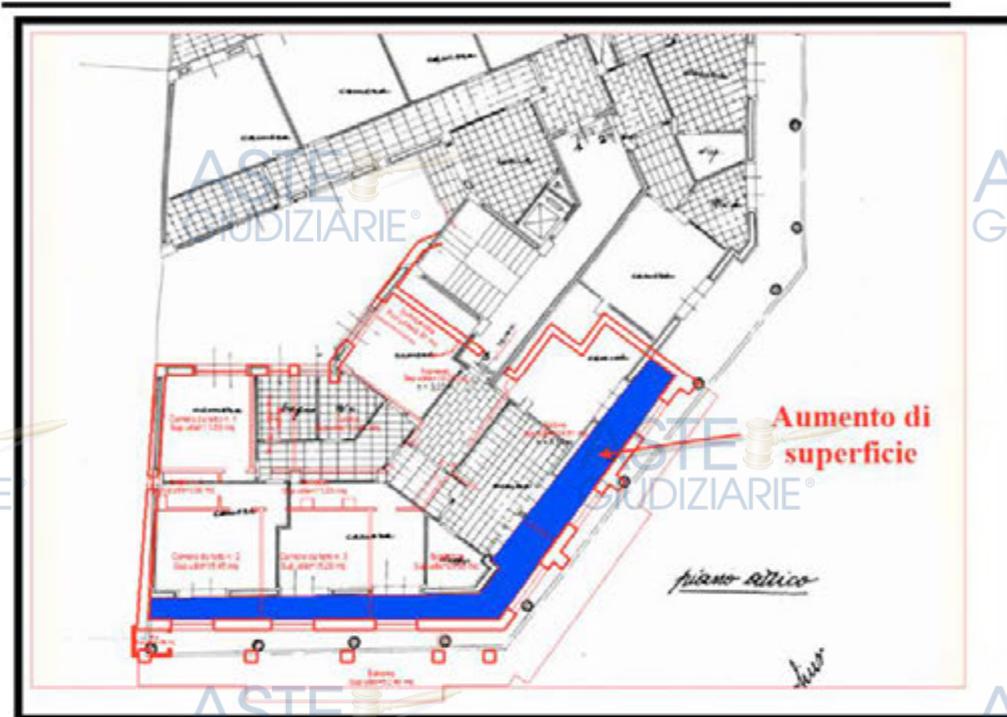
Sovrapposizione tra la planimetria allegata alla licenza edilizia e il rilievo eseguito dal sottoscritto
